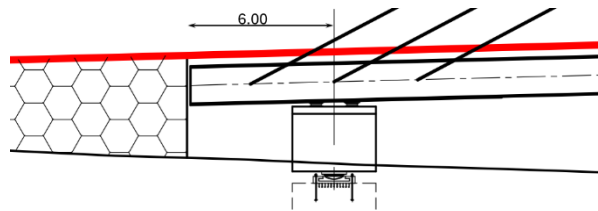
Detalle de la zona del voladizo extremo de la estructura metálica del tablero.
